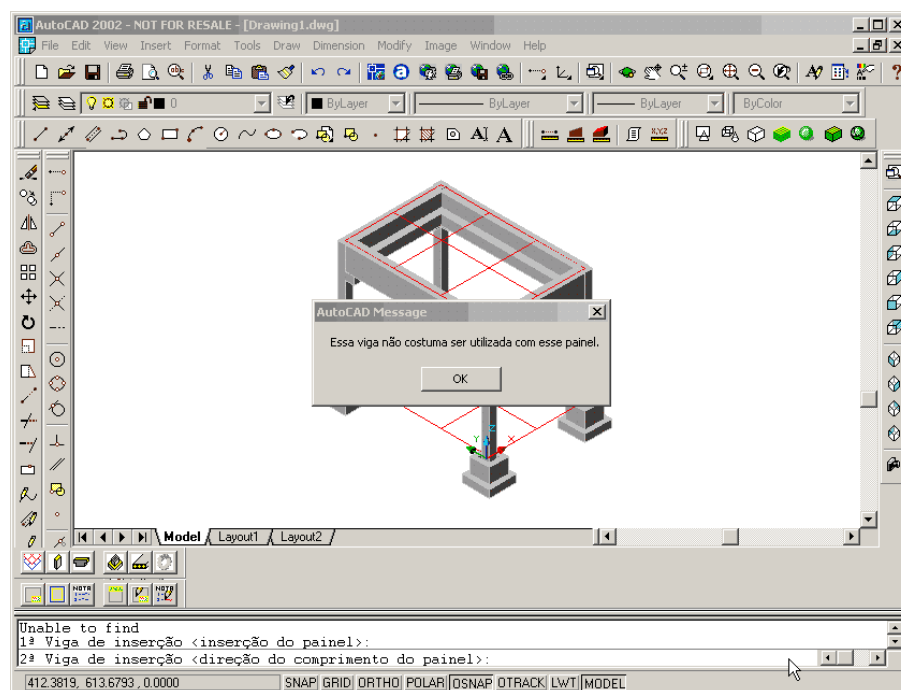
Tipo de preenchimento do vão da viga por painéis de piso.
